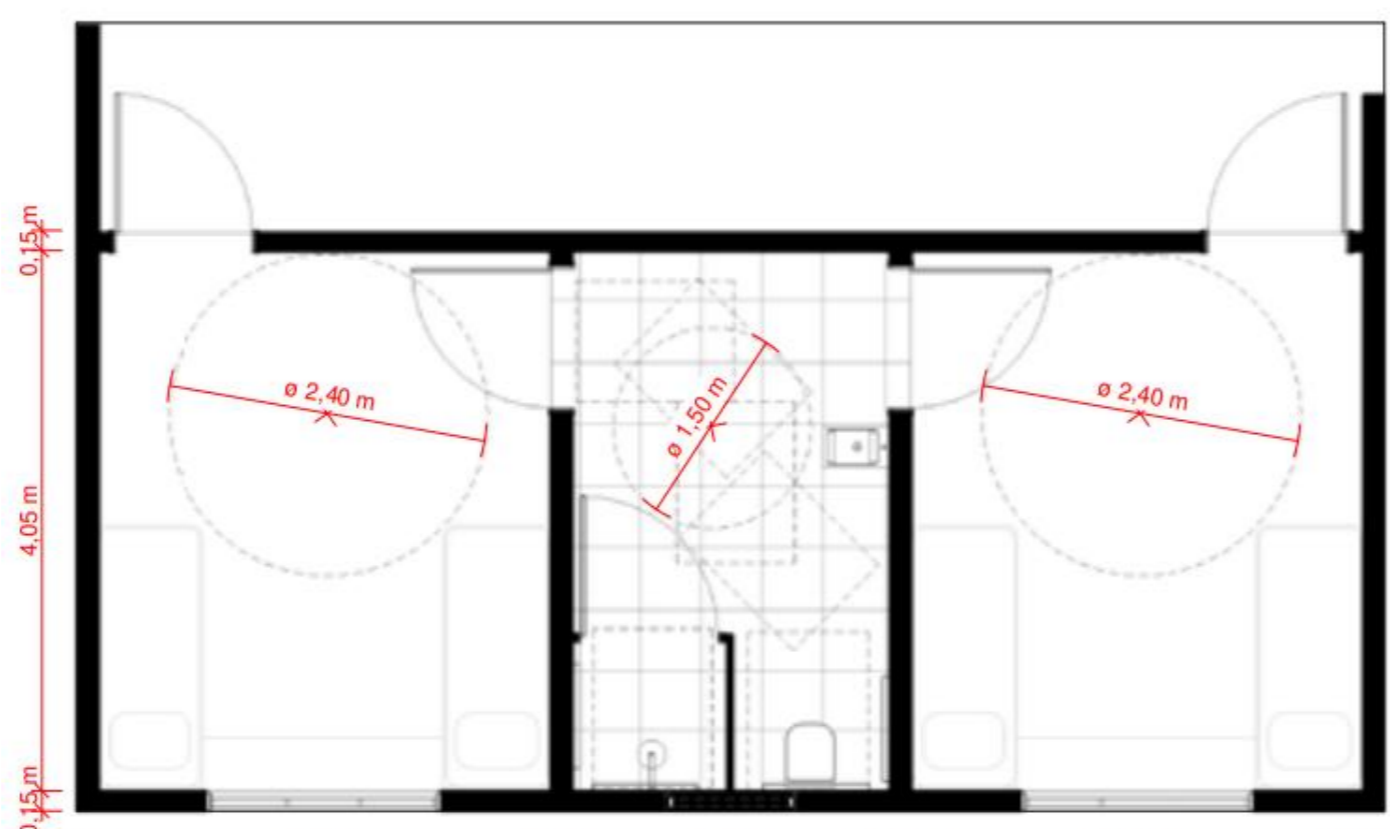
PLANTA BAIXA DORMITÓRIOS
